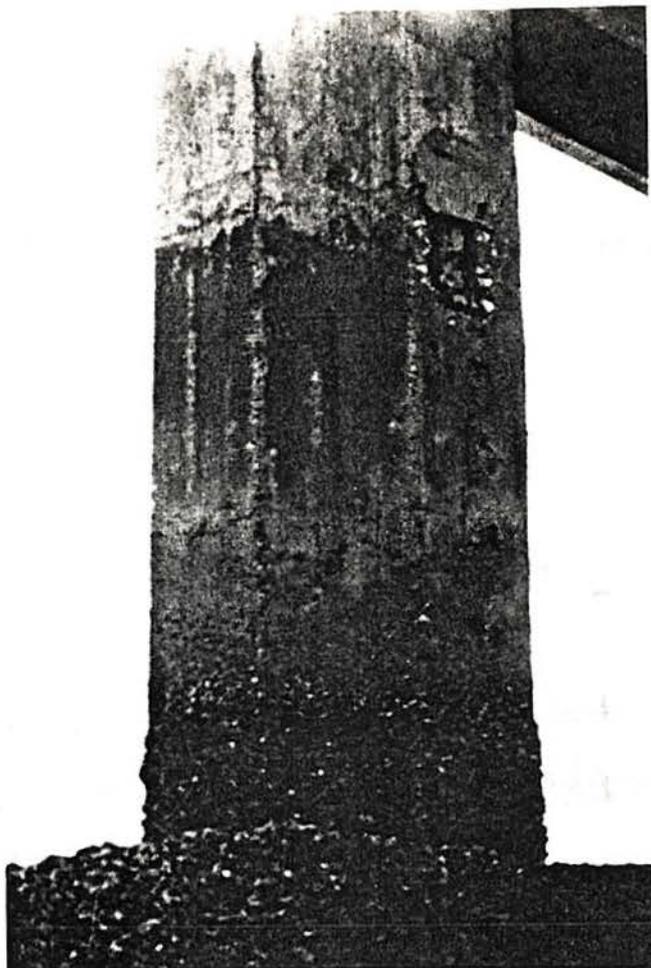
Vista do pilar de uma ponte situada em ambiente salino. Pode-se observar destacamento do cobrimento das armaduras devido ao elevado nível de corrosão localizada.
